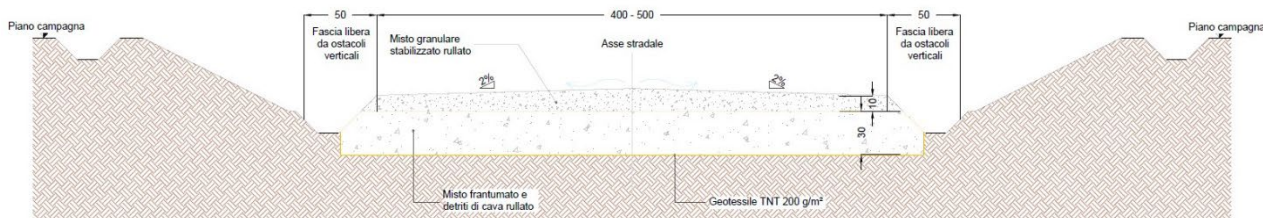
Sezione tipo pista di impianto a in trincea; misure in centimetri
